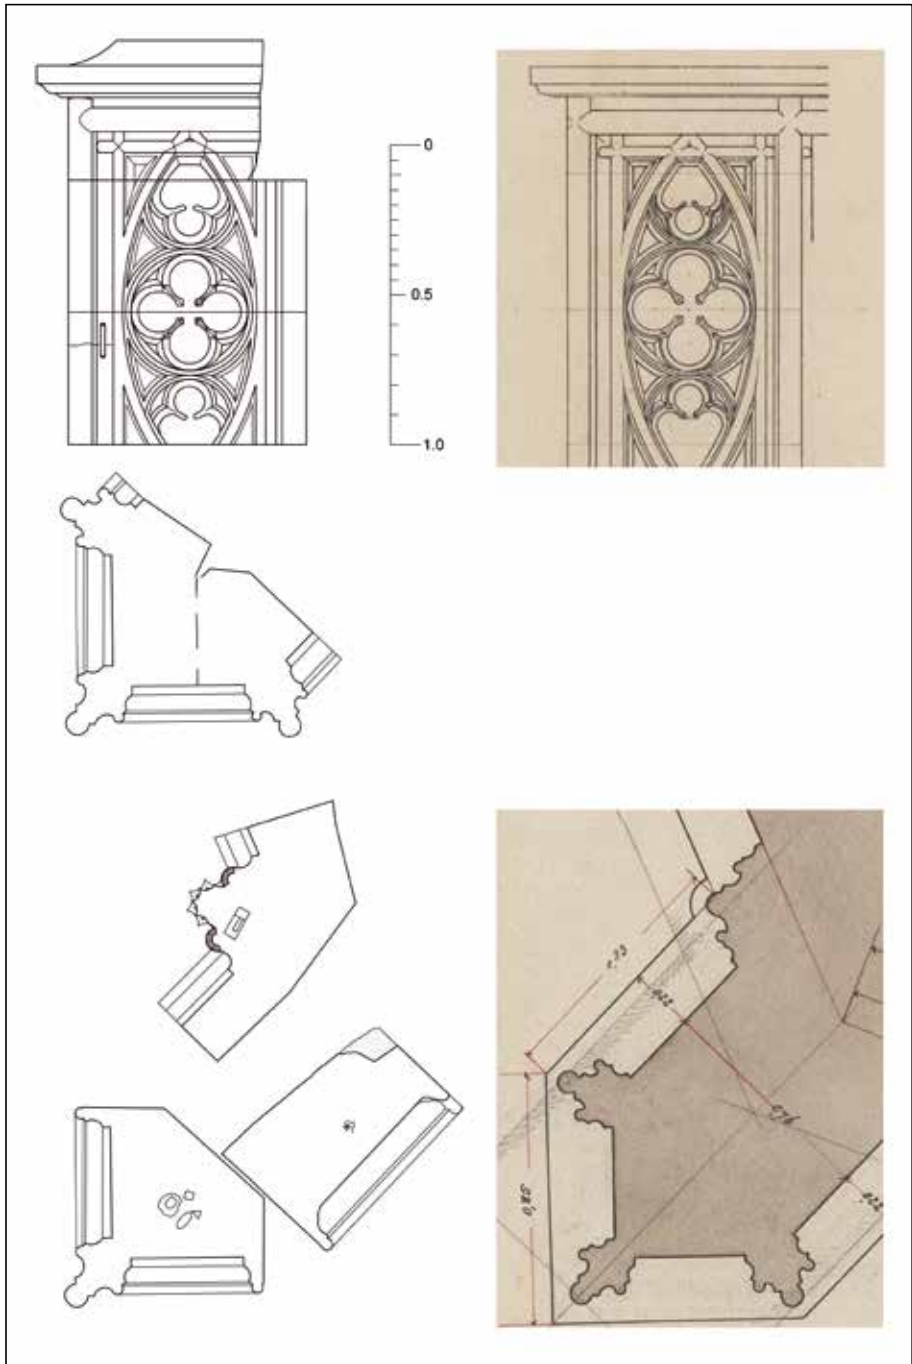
Die Werksteinstücke des Spornförmigen Strebepfeiler im Chordachraum, Ulmer Münster Nordseite, im Vergleich mit der Bauaufnahme vom mittelalterlichen Oktogon aus dem Jahr 1885/86. Bauteilaufnahme (Ansicht und Grundriss): Lisa Hofmann, Tanja Vratscha, Anne-Christine Brehm. Fachgebiet Baugeschichte KIT Karlsruhe.
